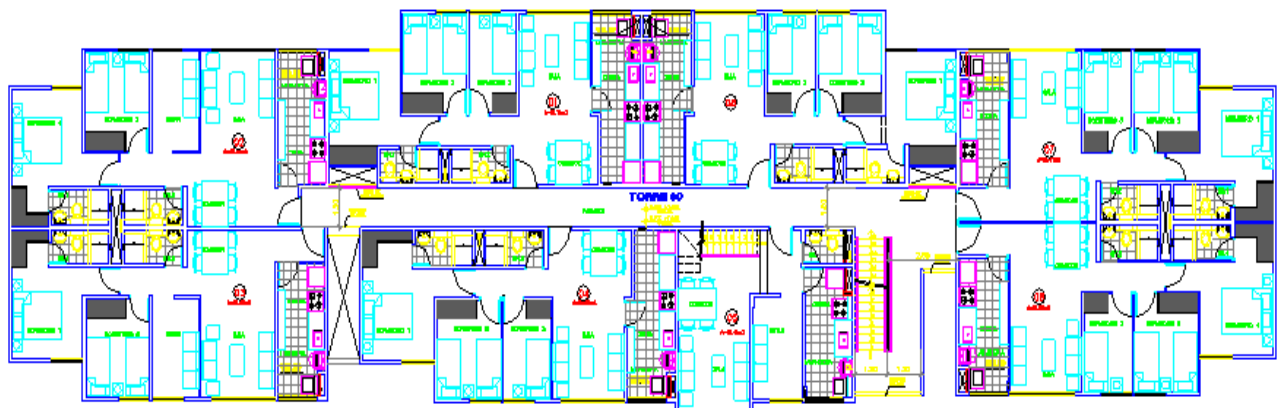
DISTRIBUCIÓN ARQUITECTÓNICA DE SEGUNDA Y CUARTA PLANTA
